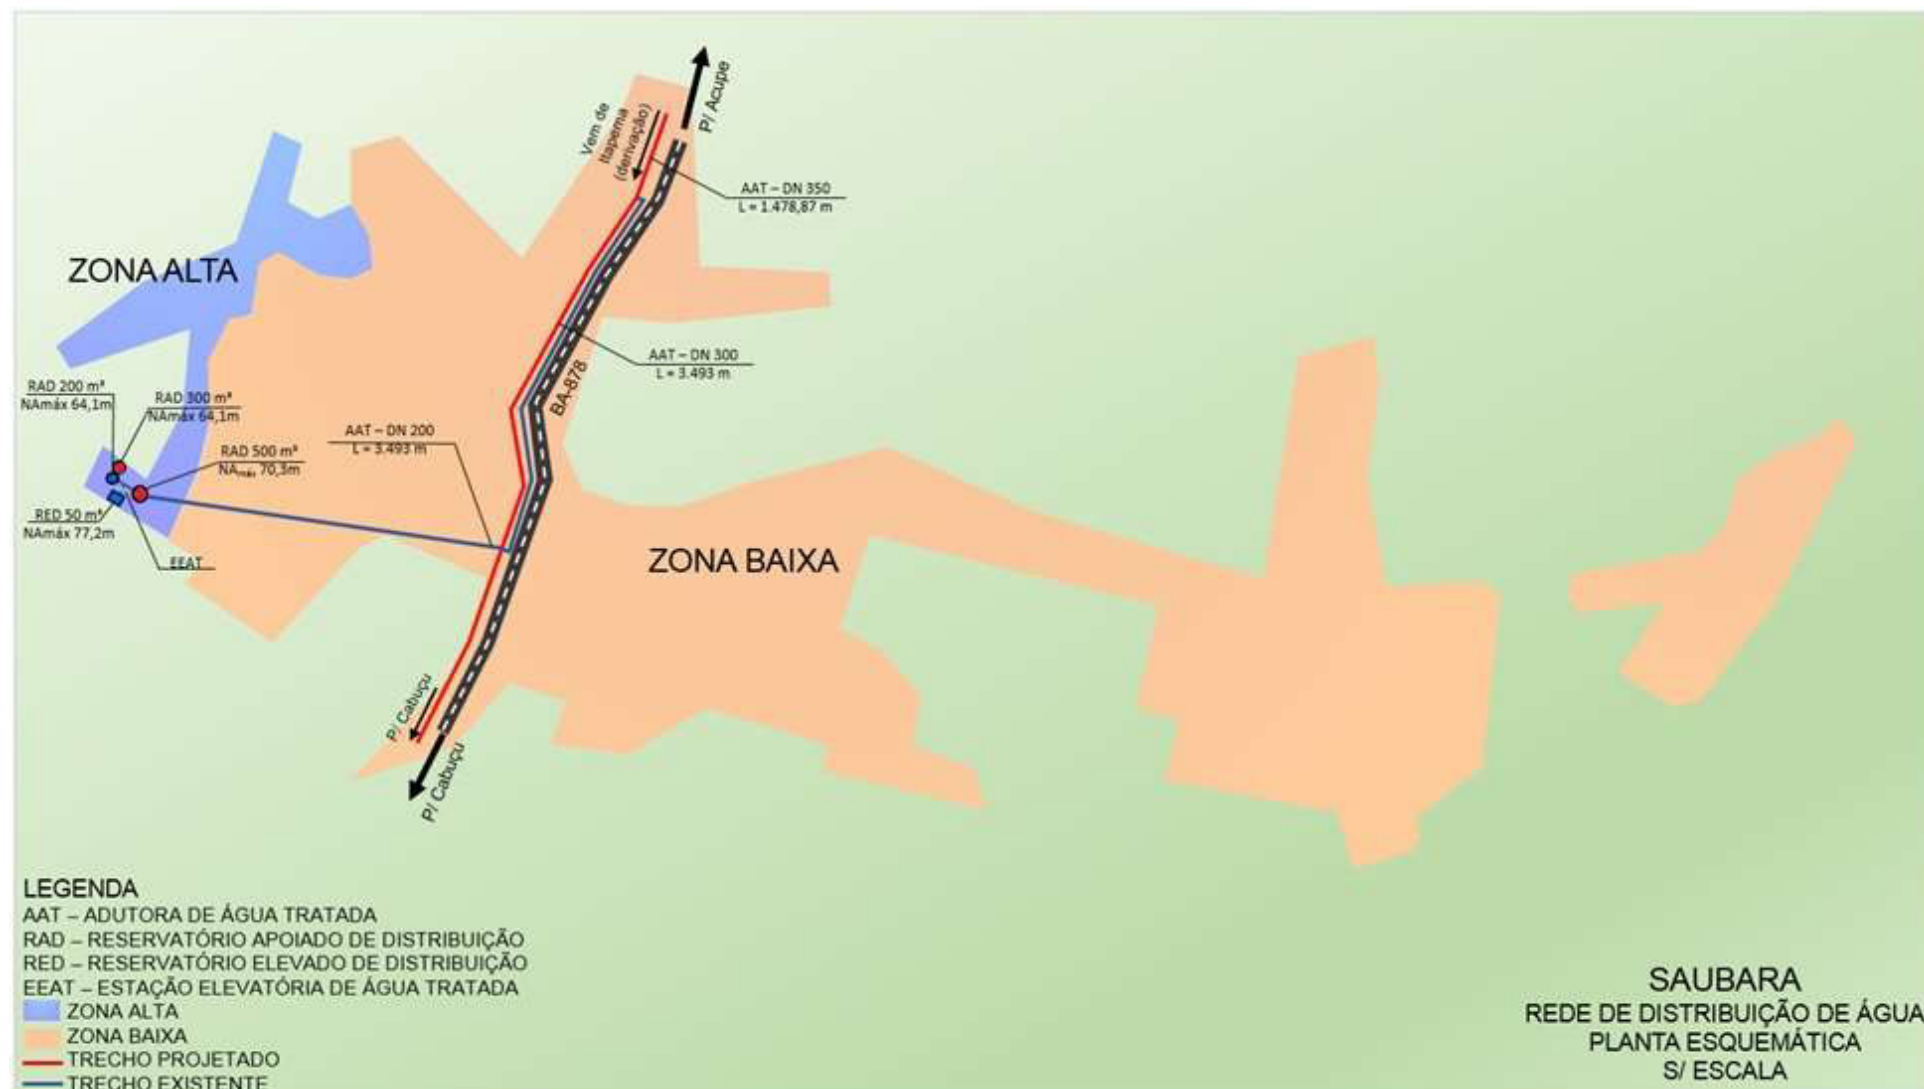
Planta esquemática das unidades principais e zonas de pressão - Saubara
